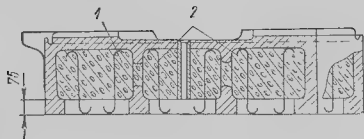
Заливка бетоном внутренних полостей фундаментных рам:
